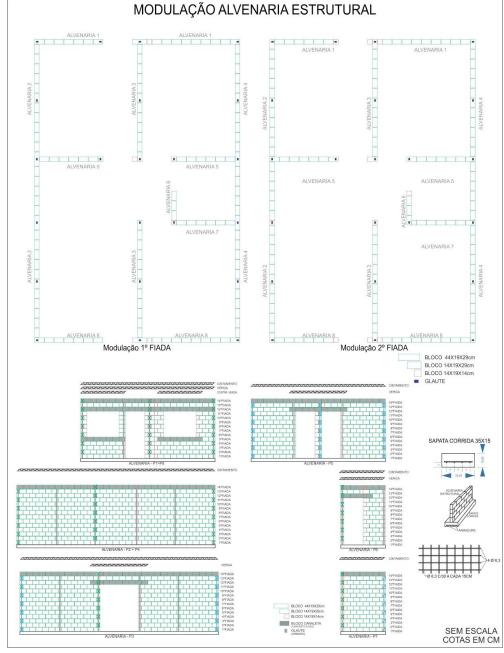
Projeto estrutural e modulação da alvenaria estrutural
